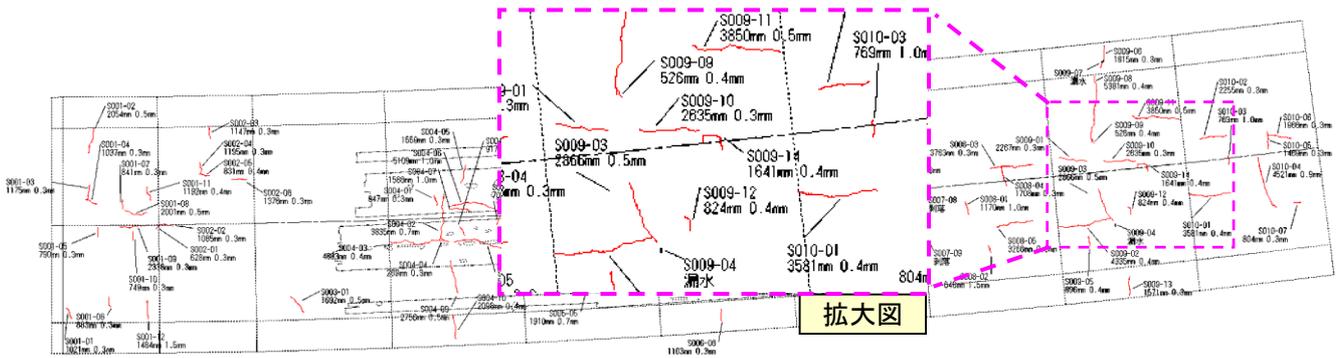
2 ひび割れ展開図 (調査区間の一部)
